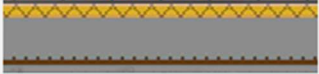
Detalle constructivo de cubierta con aislamiento térmico exterior. Elaboración propia
